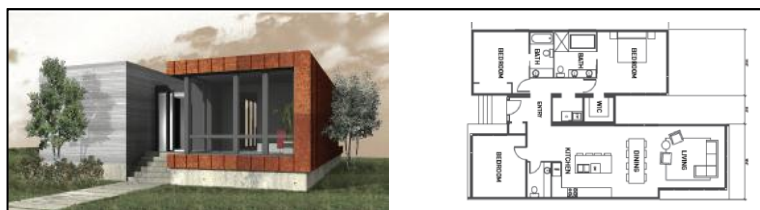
Elemental 2 – volume e planta baixa (www.methodhomes.net)
